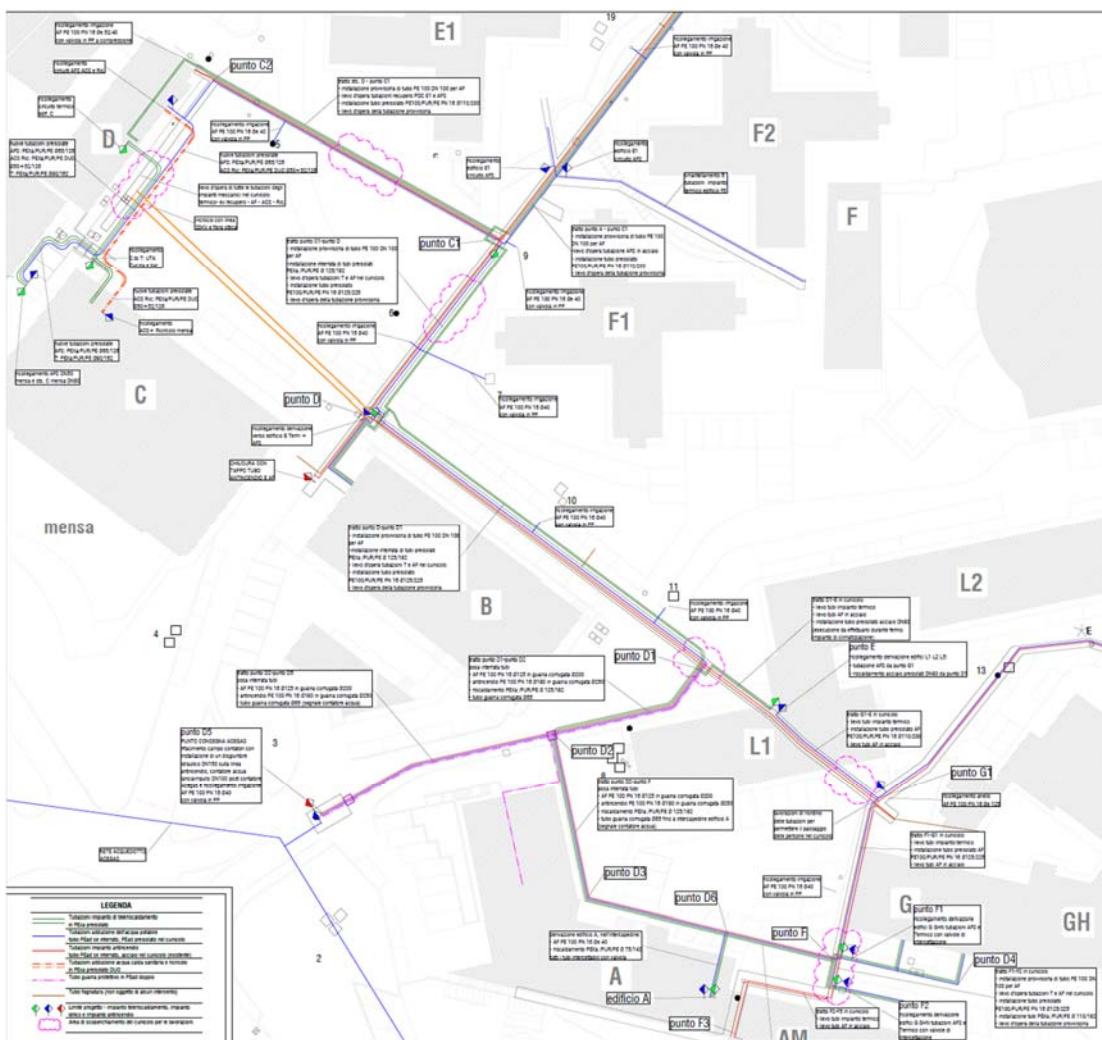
Planimetria parziale dell'intervento, estratta dal progetto esecutivo
